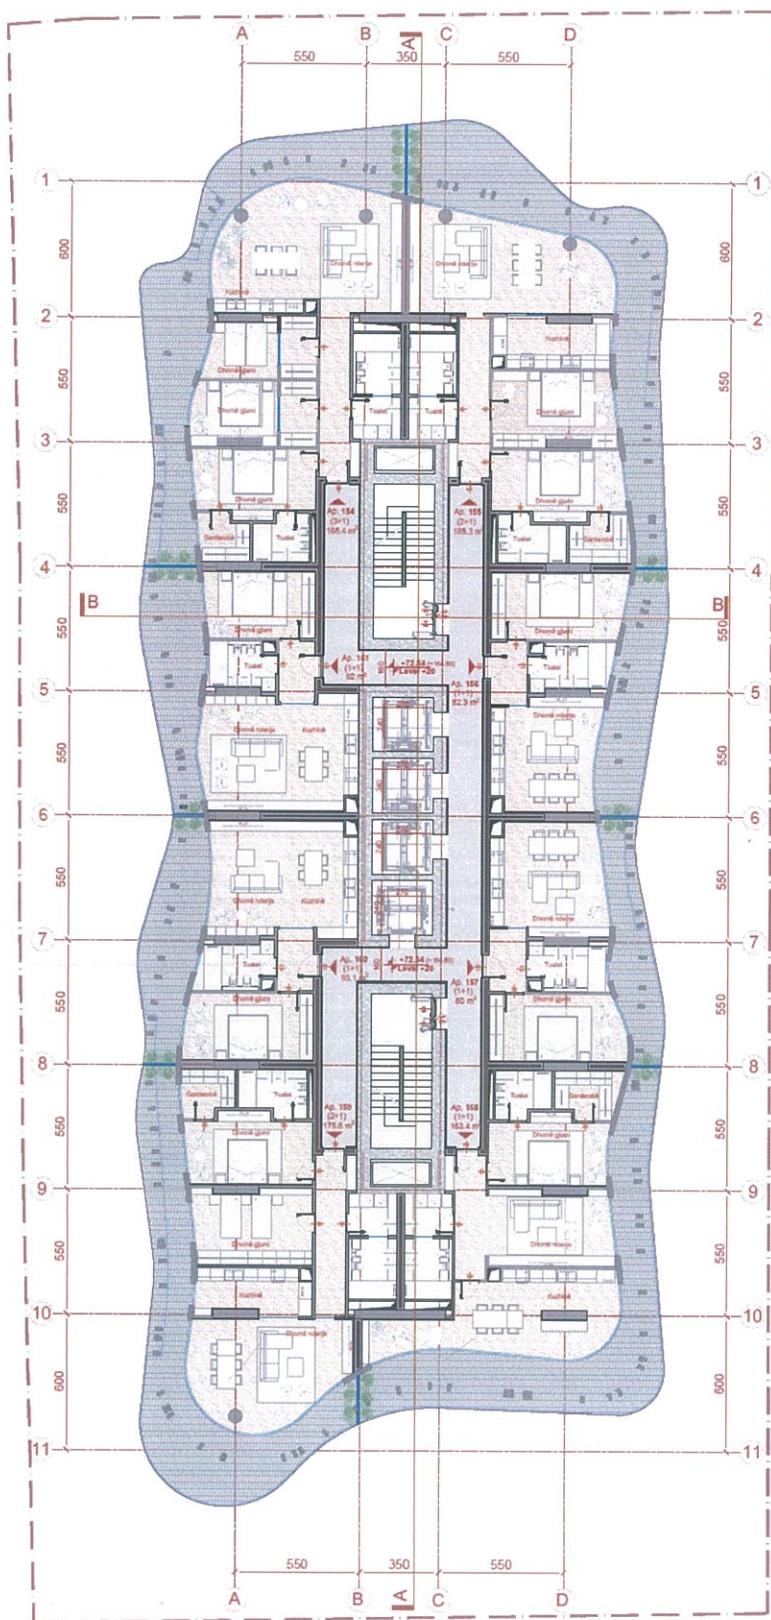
Planimetri e katit të njëzetenjë (Rezidencë)
